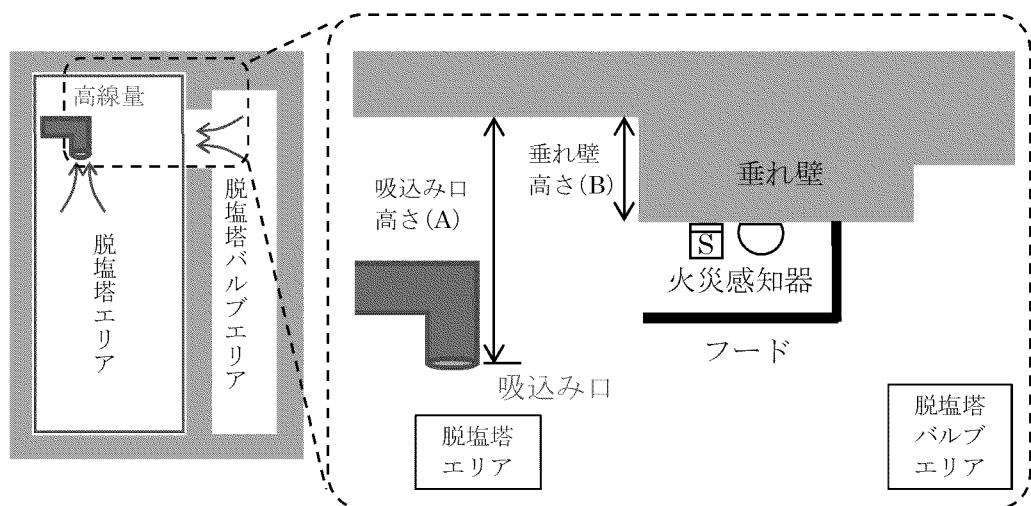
川内 2 号機 脱塩塔エリアと脱塩塔バルブエリアの配置図（平面図）
